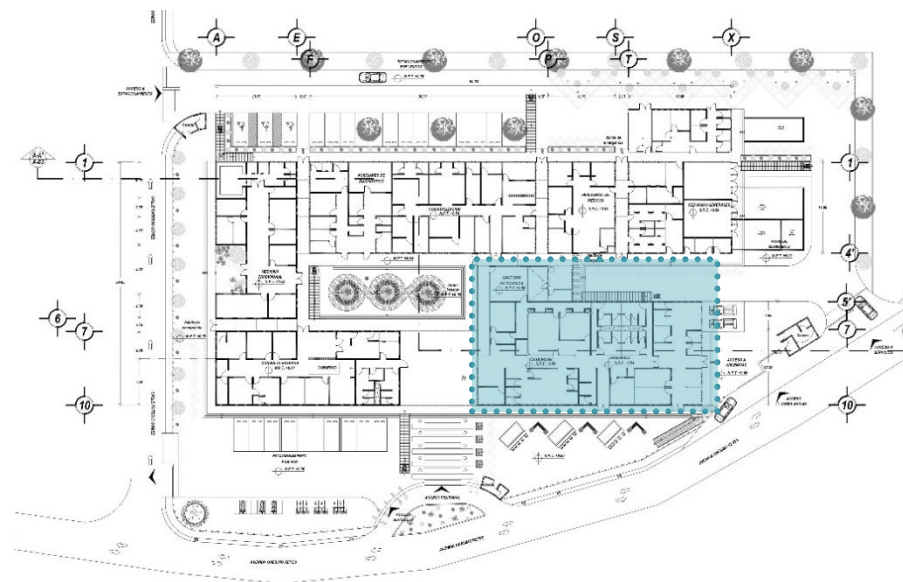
Planta baja del conjunto (Loretto, 2021).
